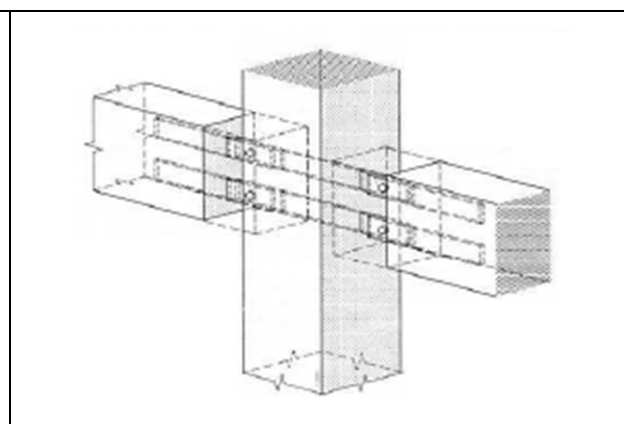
Ligação por chapas metálicas soldadas e com betonagem *in situ* (Stupré, 1981)
